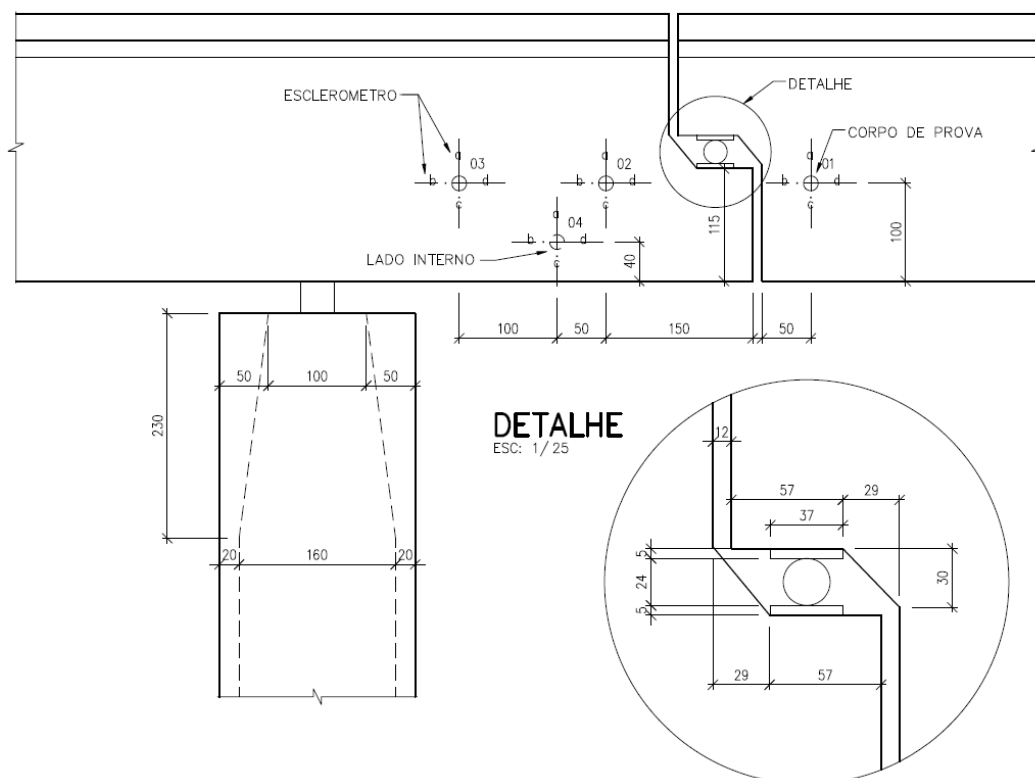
extração/esclerometria para vigas do vão central (junto ao dente Gerber)
